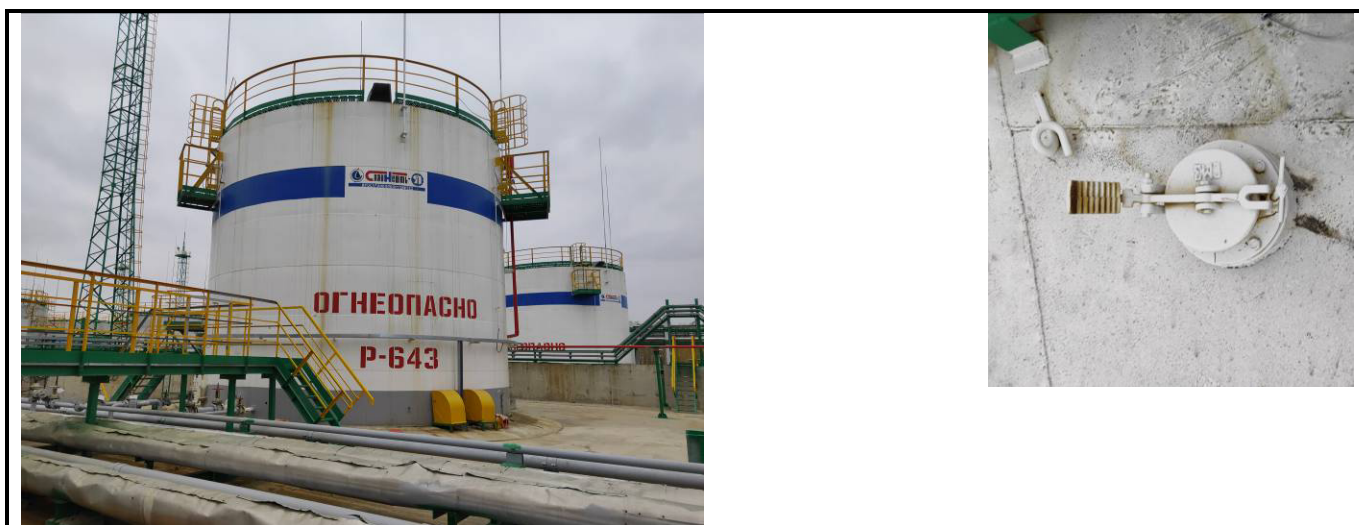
Общий вид резервуара РВСП-700 (№Р-643) с замерным люком
